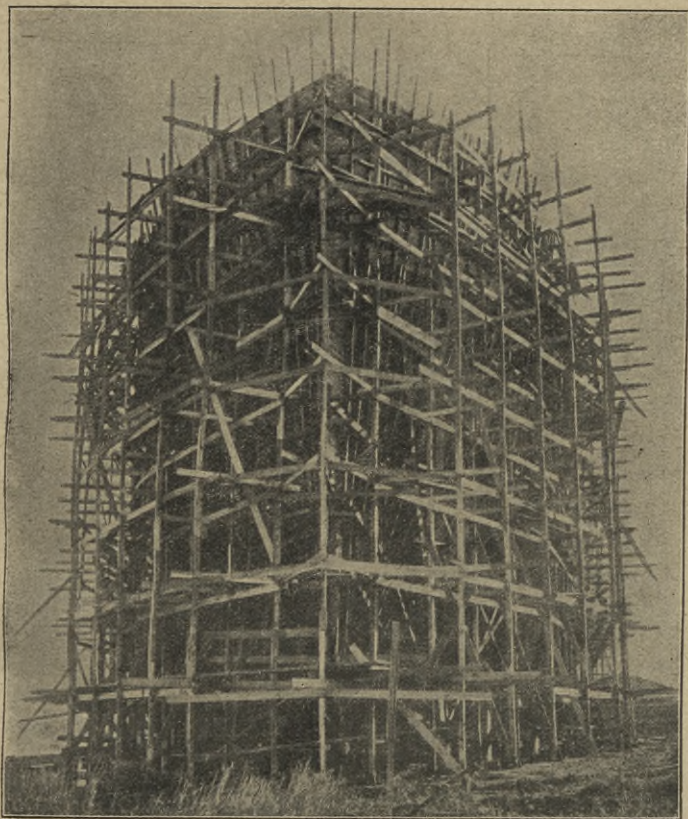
Eisenbetonschiff von 7900 Tonnen, Bauweise Alan Mac Donald und Kahn. Außenschalung am Vordersteven mit Baugerüst.
